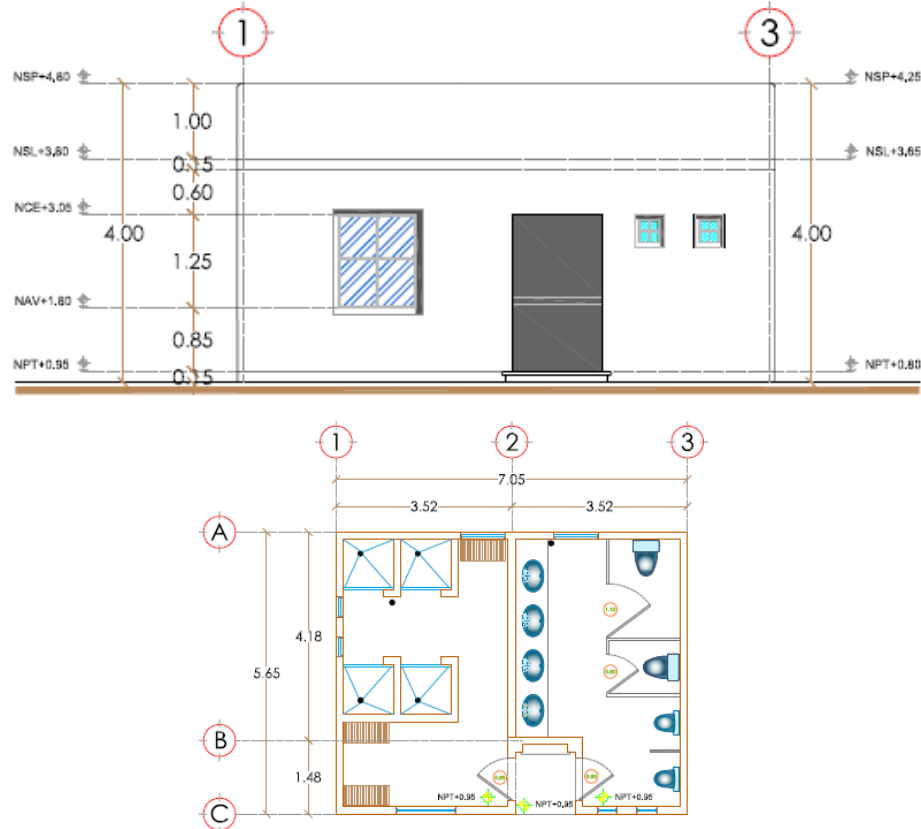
Alzado arquitectónico Área de Baños-Ducha
